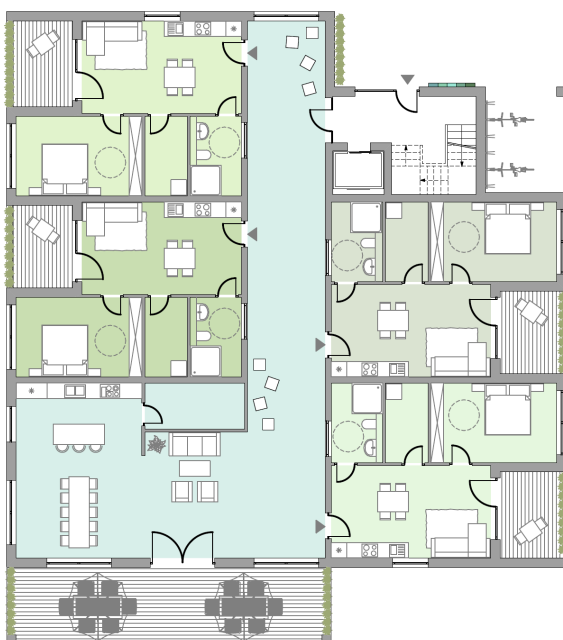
Grundriss gemeinschaftliches Wohnen (eigene Darstellung)
